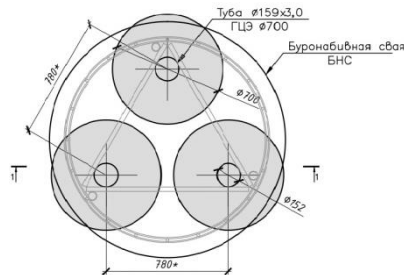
Сечение грунтоцементного элемента опоры №3
